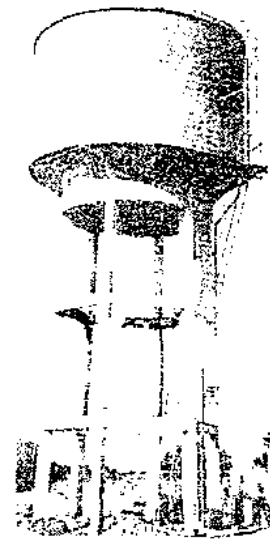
Estanque elevado de concreto armado de forma cilindrocónica. Potrerito, Estado Zulia. Venezuela.
